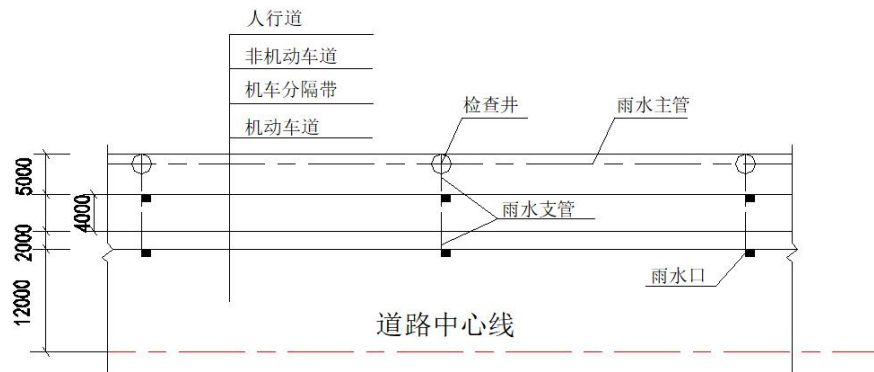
半幅路雨水管道平面示意图 (单位: mm)
